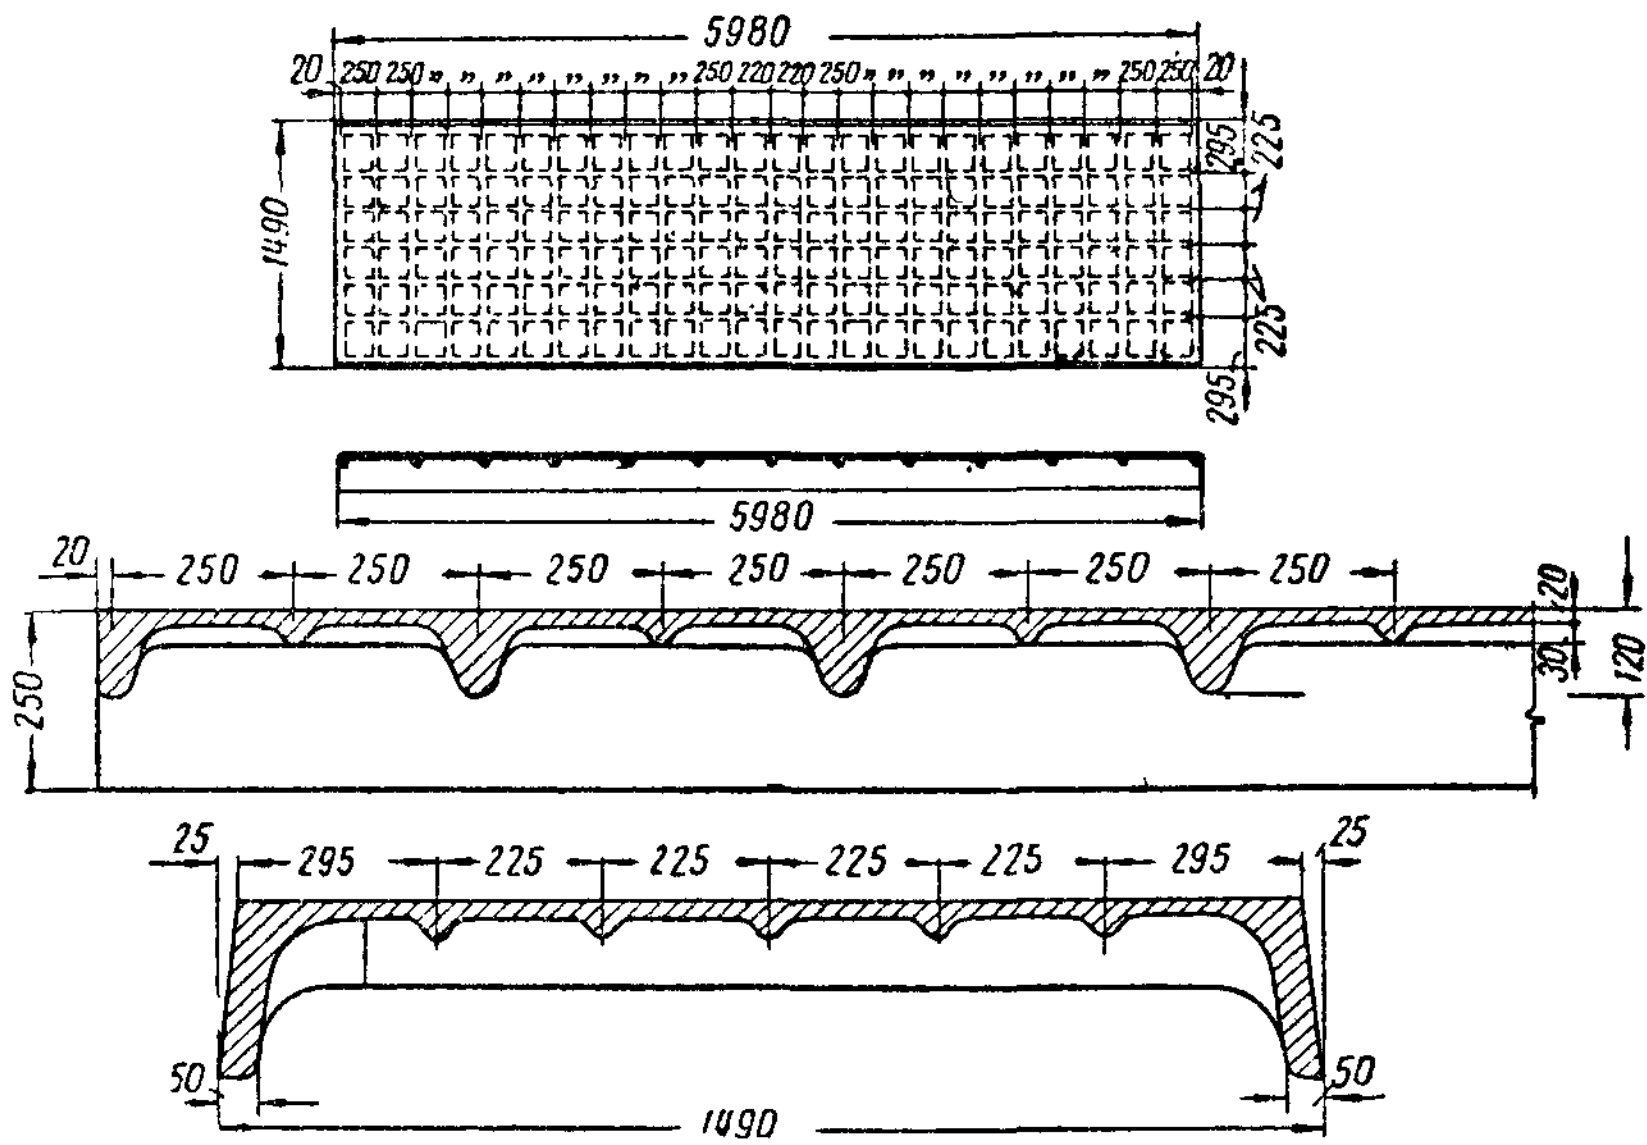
Крупнопанельная железобетонная часторебристая плита
